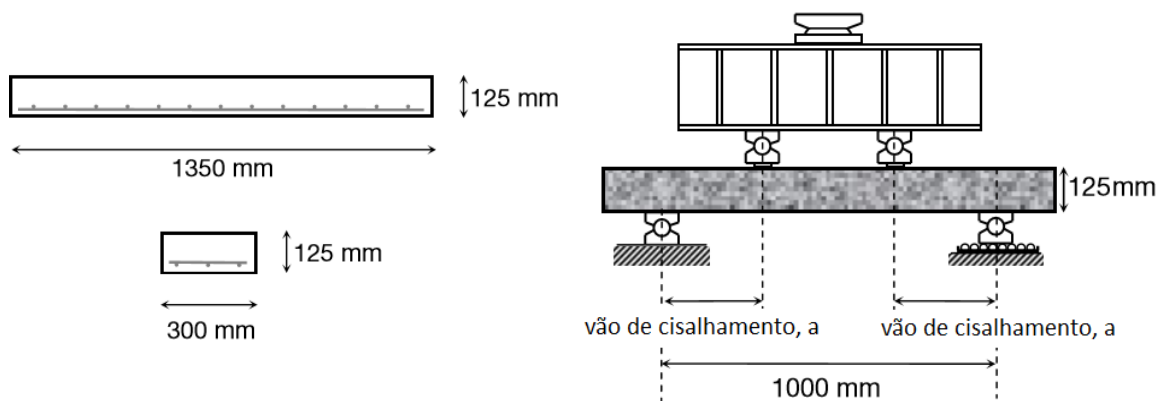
Vigas da série-S, dimensões e setup de ensaio (Juan, 2011).
